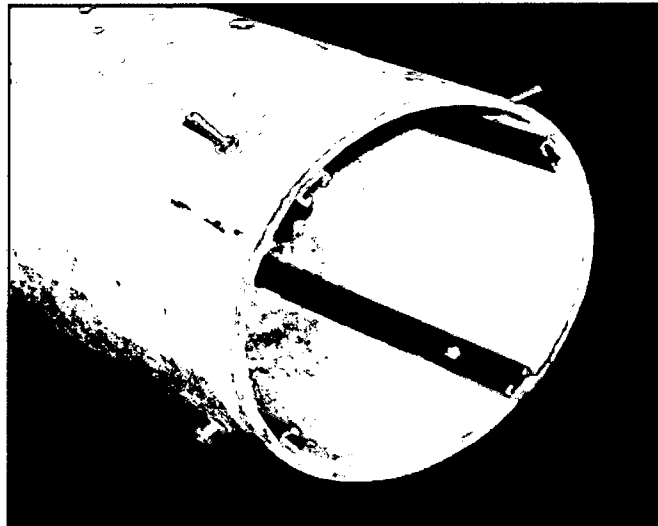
Rieles dentro de tubería metálica para el desplazamiento
